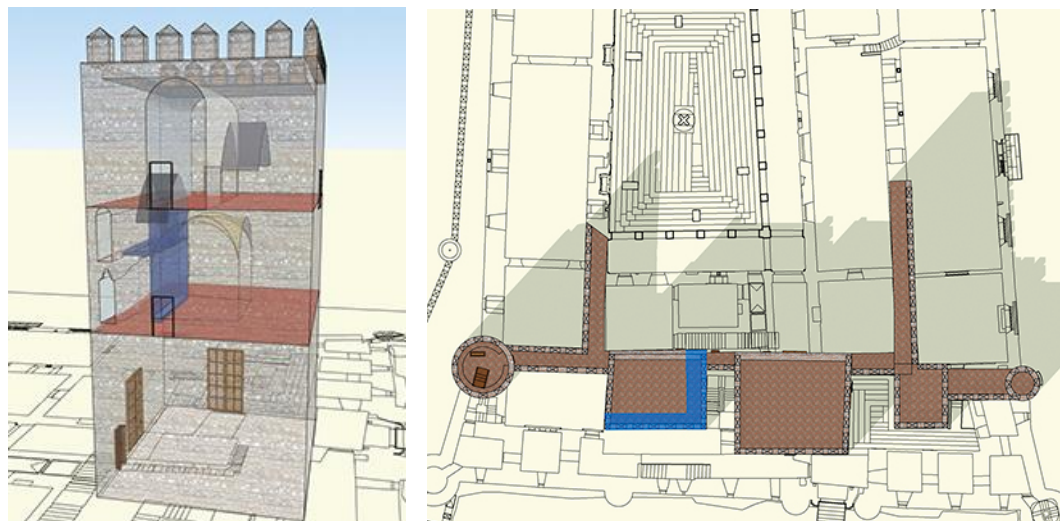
Interior de la torre central tras la construcción de la segunda planta.
